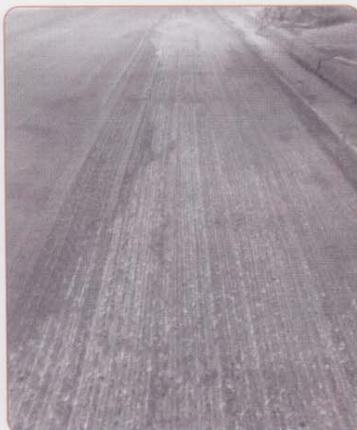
Aspecto de la calle Cosquín entre Boquerón y Pribebuy, antes de efectuar el riego de adherencia. Sector central con arena-asfalto y sector lateral fresado contra arcén y bordillo de hormigón.
